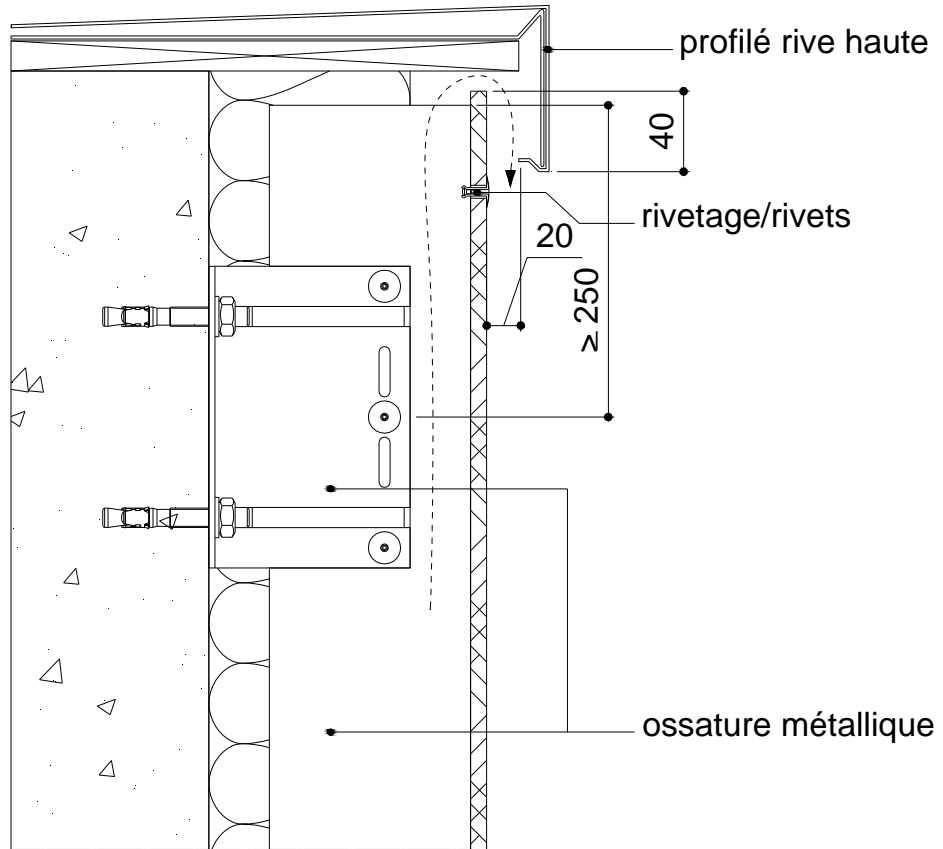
Détail arrêt sur acrotère sur ossature métallique (cote en mm)
